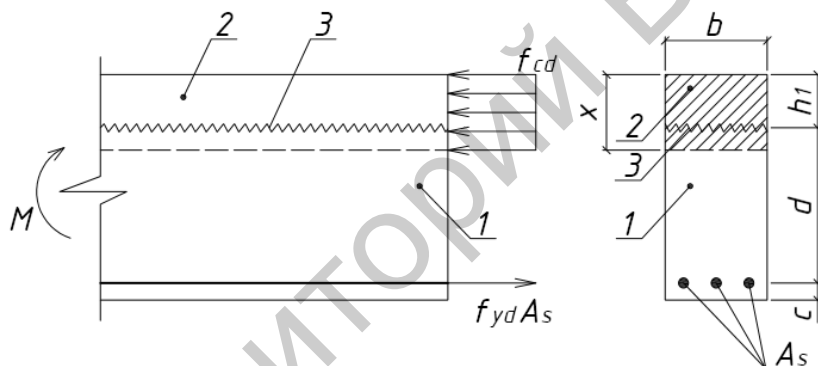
Расчетная схема усилий нормального сечения изгибаемого элемента, усиленного наращиванием сжатой зоны. 1 – балка пролетного строения; 2 – монолитная плита усиления; 3 – граница сцепления между старым и новым бетоном.
